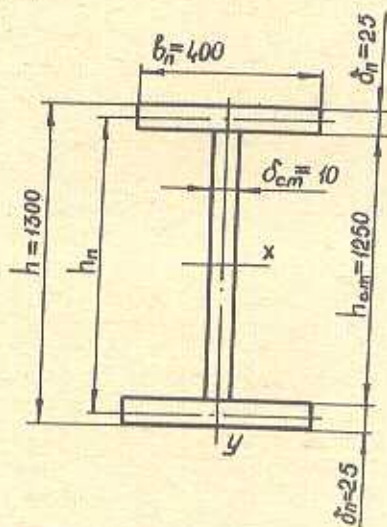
Спроектированное сечение сплошной сварной балки
